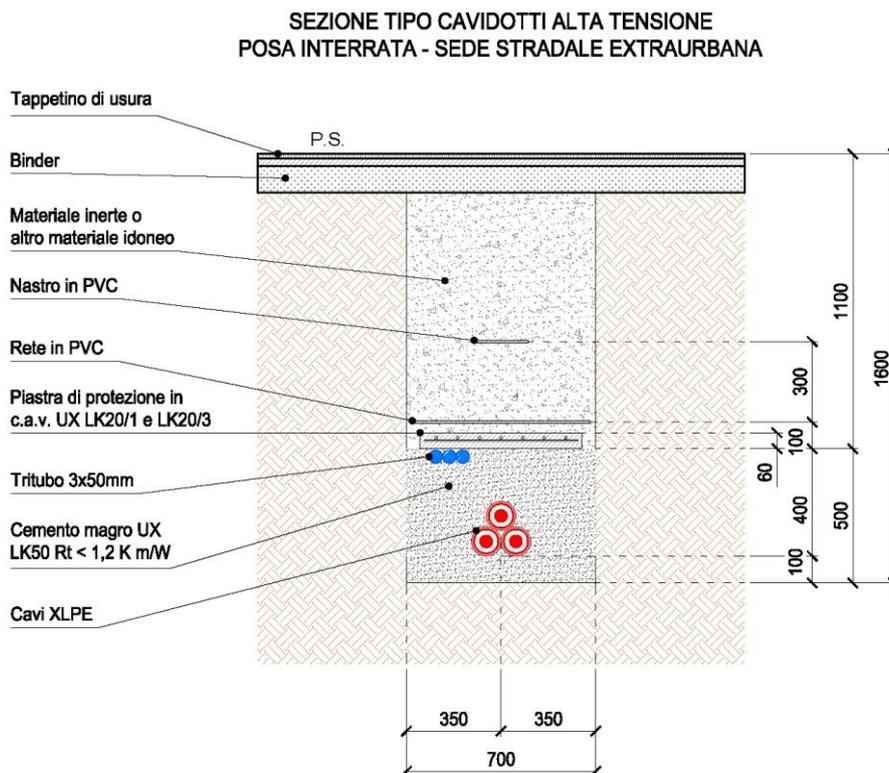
Modalità di posa sotto il piano stradale (Elaborazione iLStudio).
